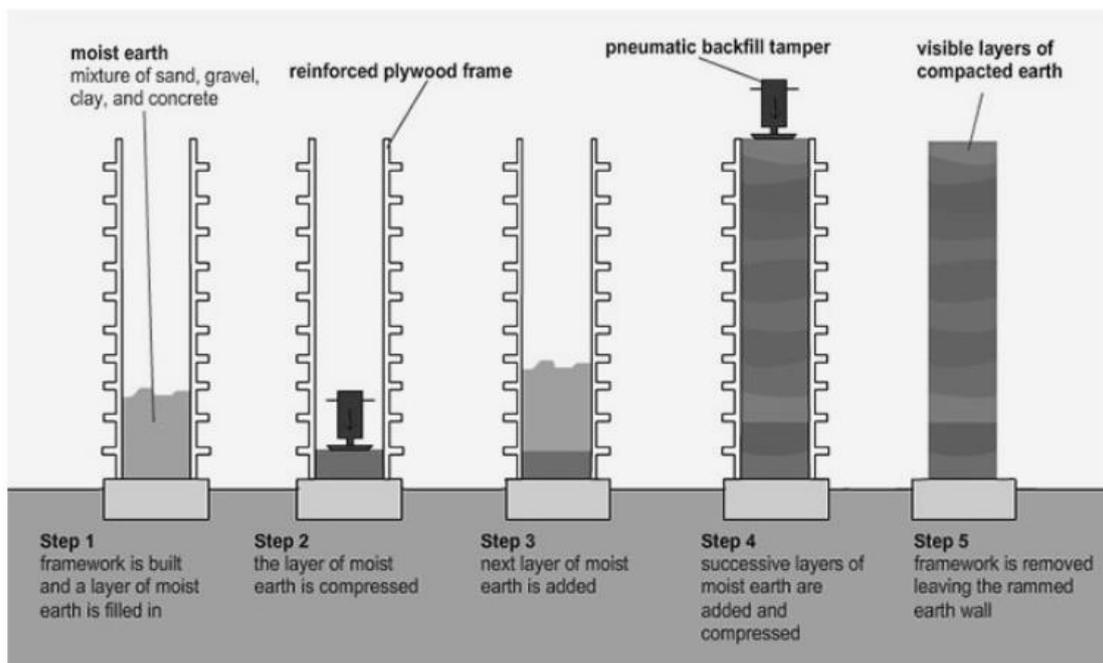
técnica constructiva del muro de tierra comprimida fuente: <http://www.greenspec.co.uk/building-design/rammed-earth/>
